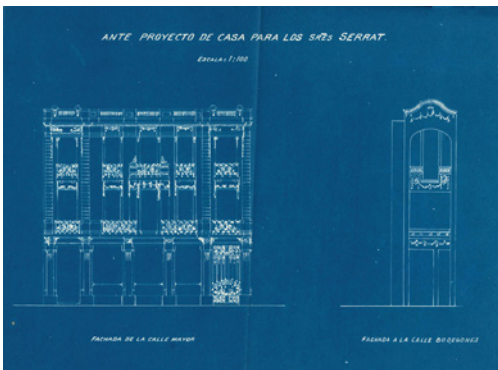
Anteproyecto de las fachadas de la fachada de la Casa Serrat. Archivo Lorenzo Ros.
